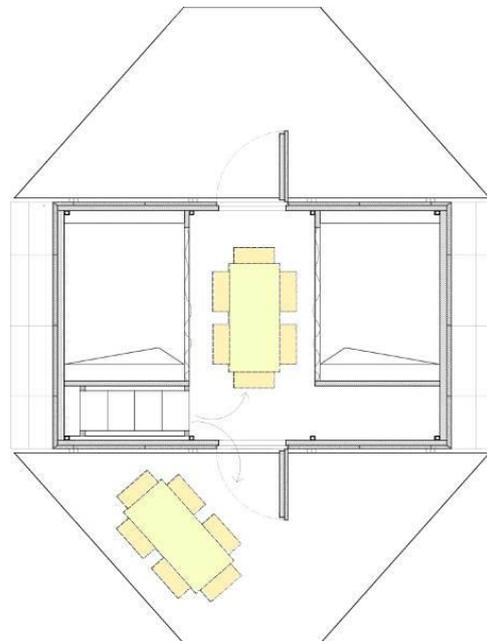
Planta Cota 0,41; zonas de utilização da mesa e dos bancos
